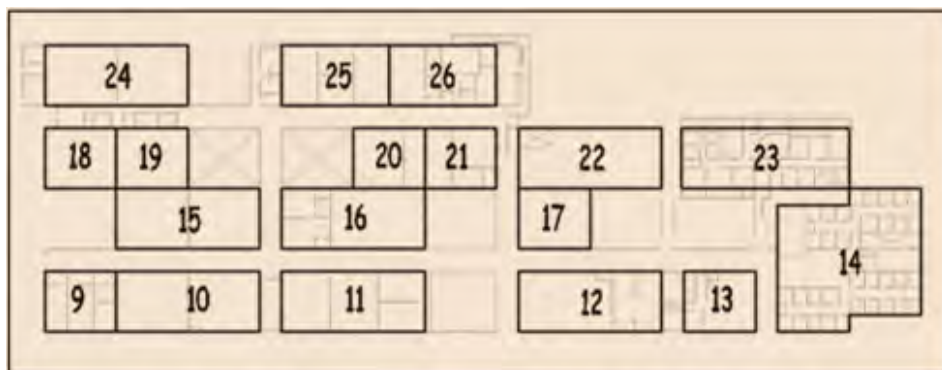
Sectores segunda planta bloque uno Universidad de Nariño
